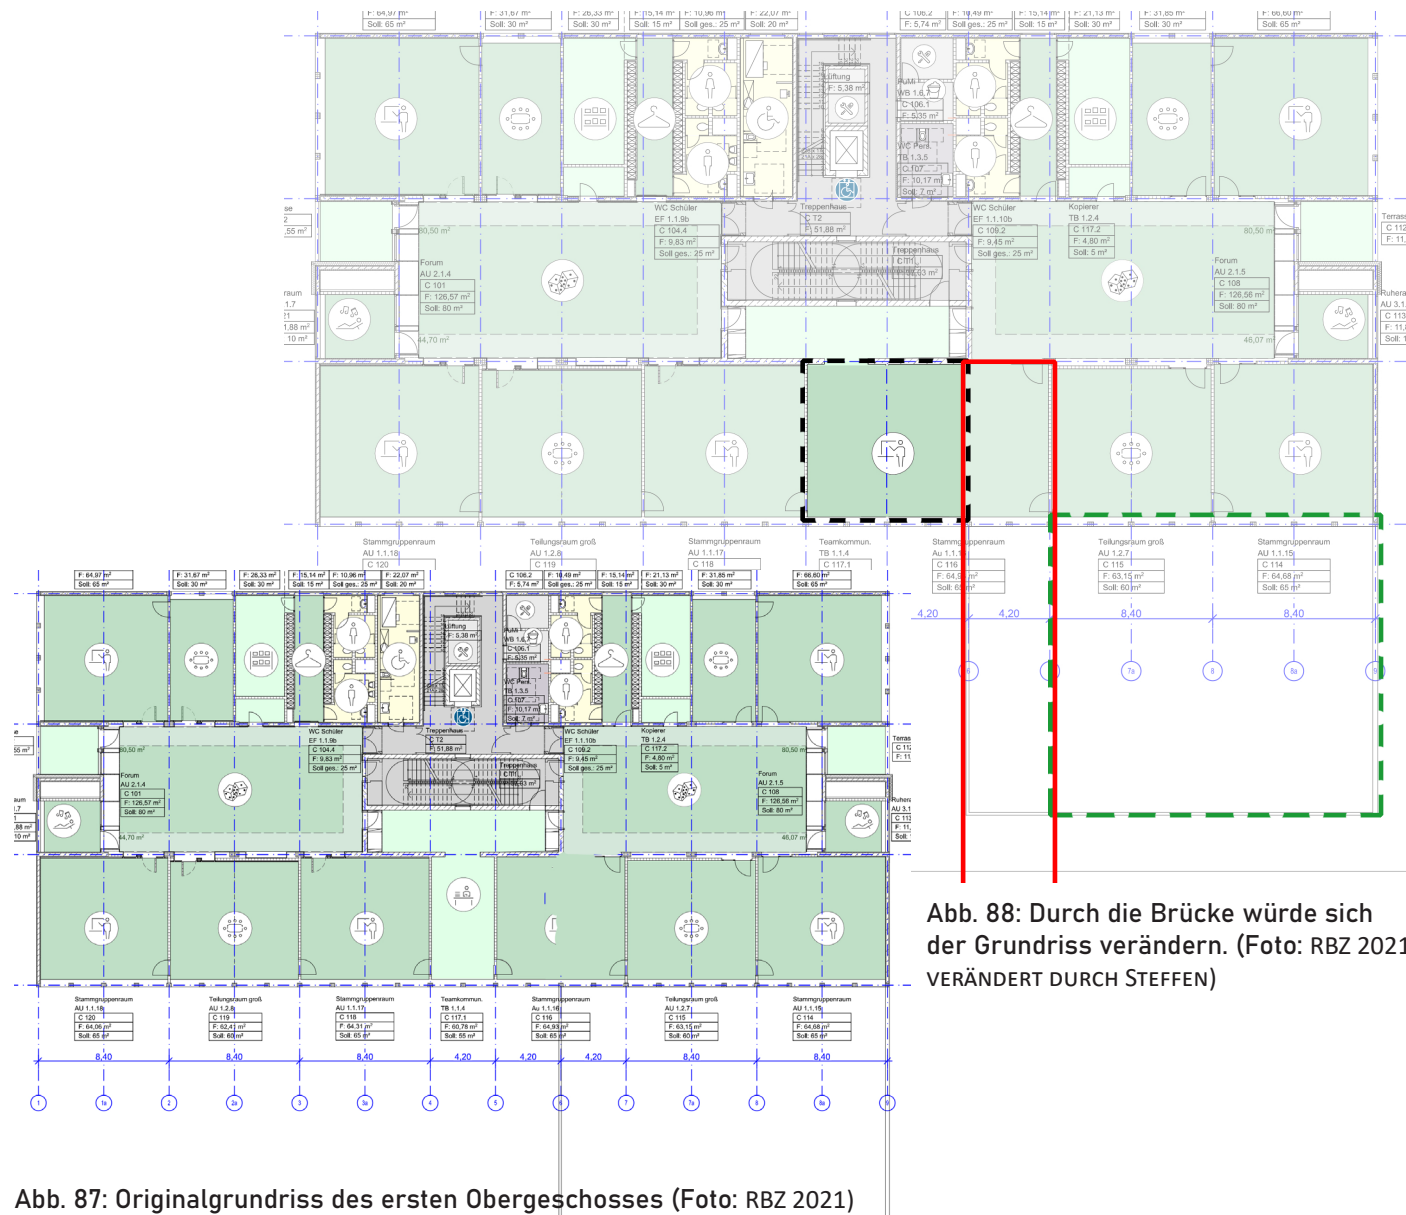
Durch die Brücke würde sich der Grundriss verändern. (Foto: RBZ 2021 VERÄNDERT DURCH STEFFEN)
